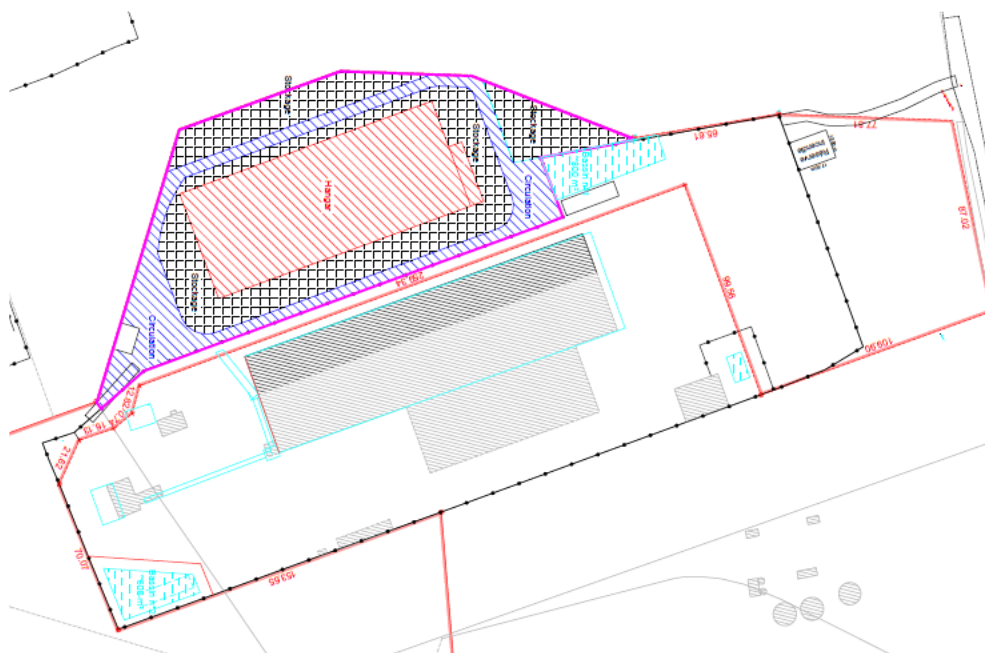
Plan d'aménagement prévisionnel de la plateforme - SEA TECH - 16/02/2024
